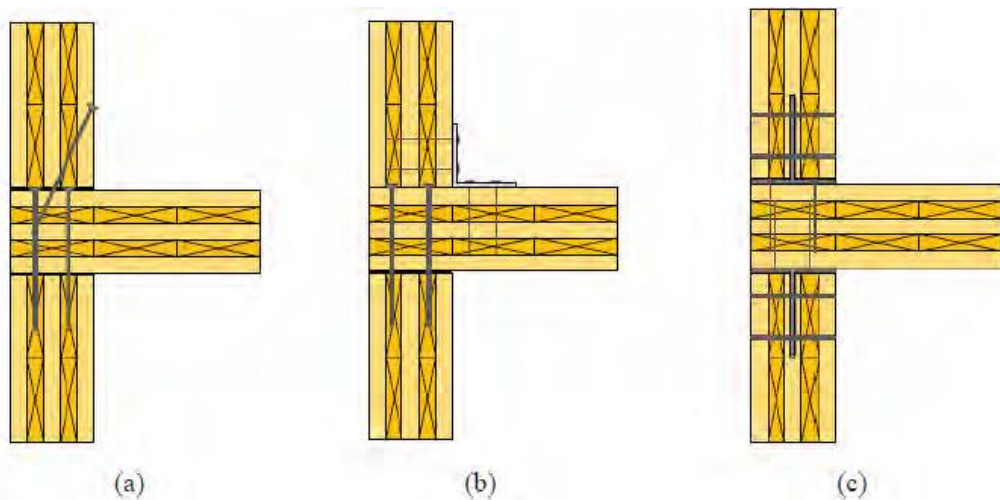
Ligação do tipo parede – pavimento usadas no sistema construtivo *platform system*: (a) Ligação com parafusos auto-perfurantes; (b) Ligação com cantoneira metálica; (c) Ligação com placas metálicas escondidas (Mandegarian e Milev, 2010).
